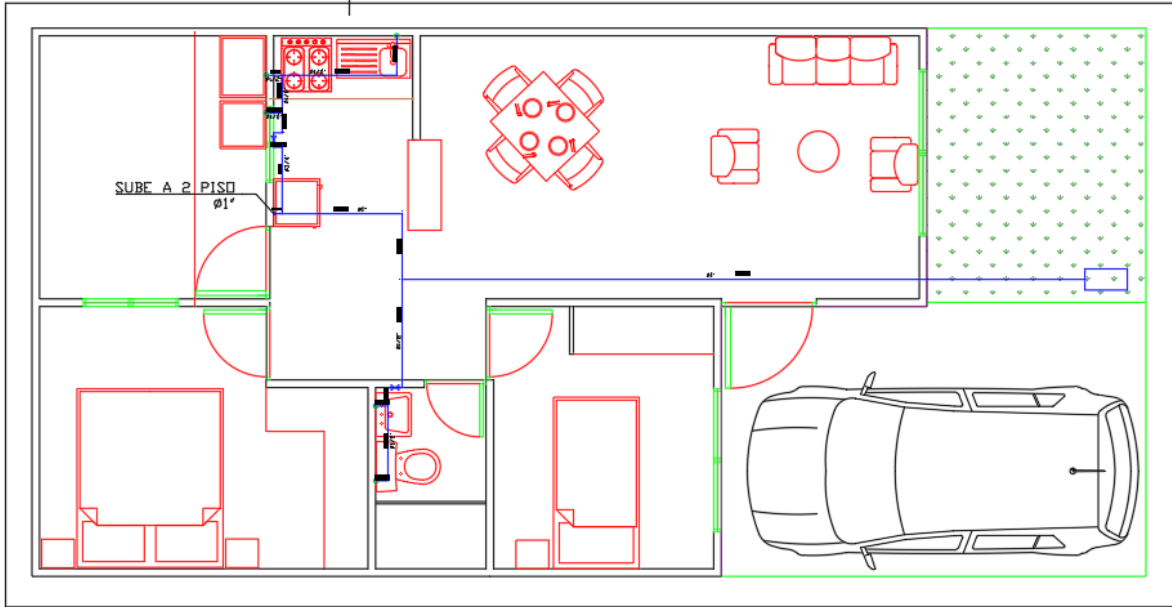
Plano Diseño Red Instalación Hidráulica Casa Torcaza 2 pisos
